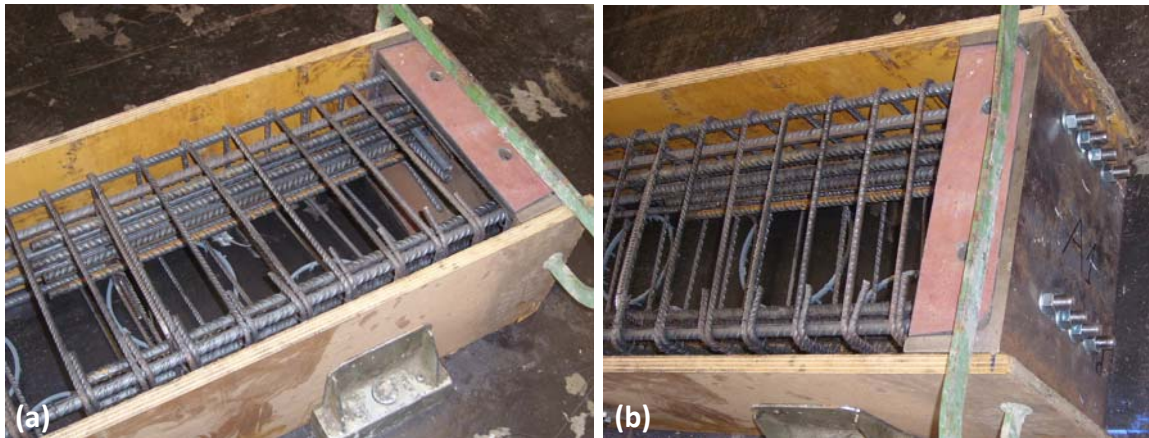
Barras corrugadas embebidas en la probeta para asegurar la conexión entre la probeta y el pórtico de ensayos
